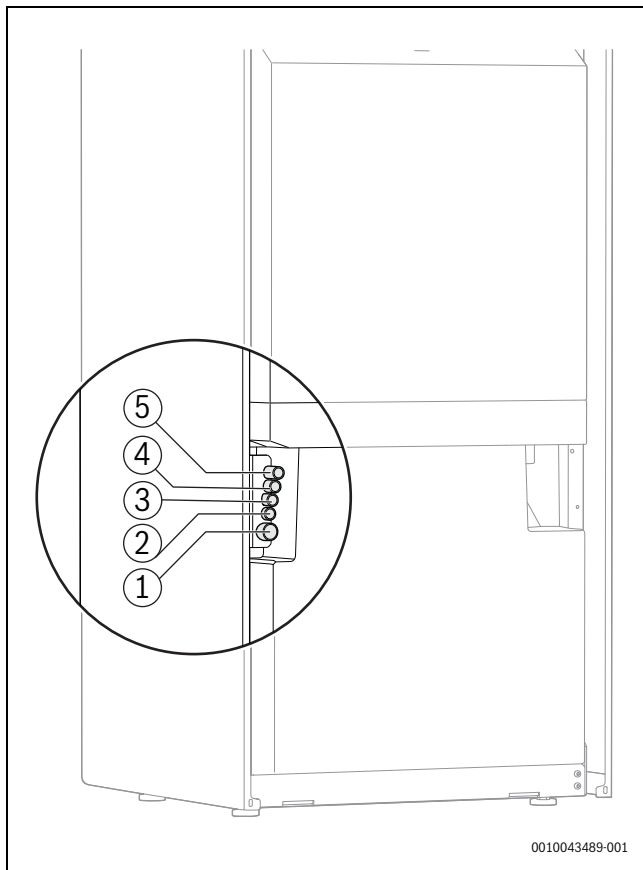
Vue de derrière : passage du câble de réseau dans l'unité intérieure
